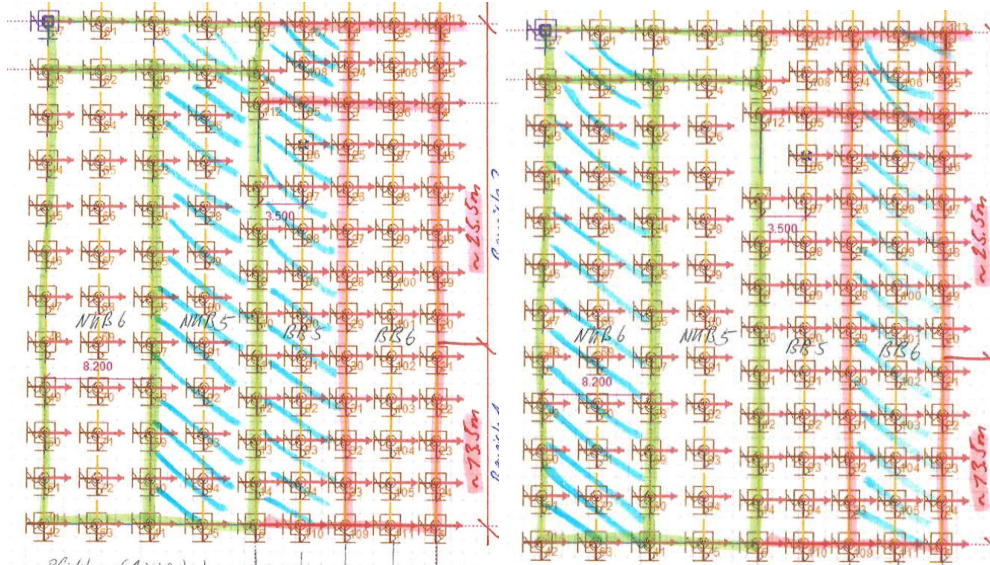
Belastungsschema; Grundriss Beckenblock BB und NKB («blau» Becken mit RWSP)
